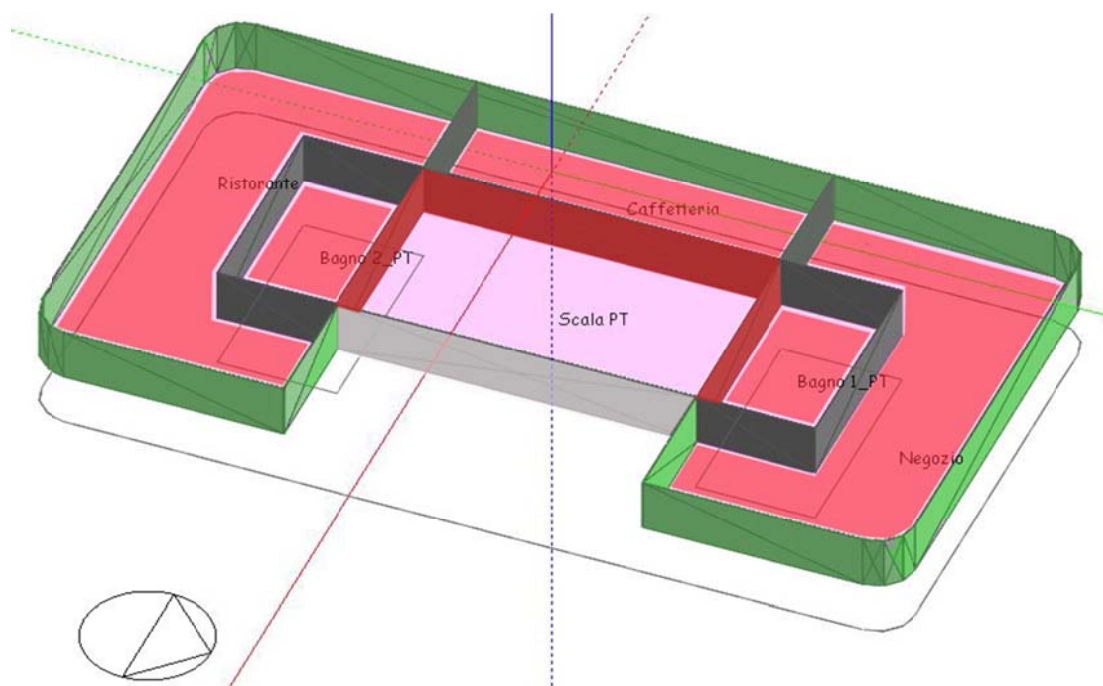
Suddivisione in zone termiche del piano terreno, in applicazione della UNI/TS 11300.
